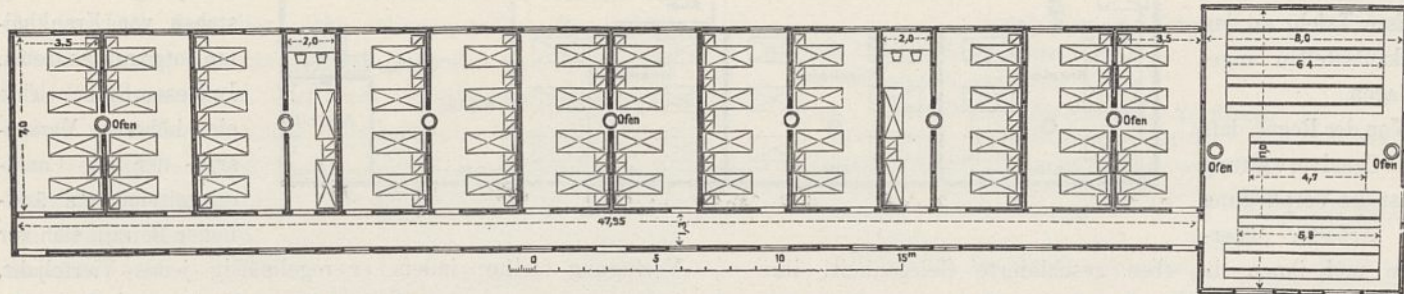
Grundriß einer Schlafbaracke für 100 Mann.
